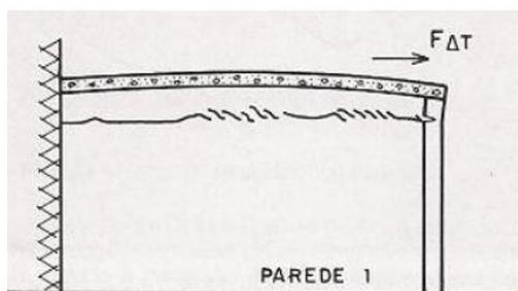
Fissuras que ocorrem nas lajes por movimentações térmicas, tipicamente horizontais, linha paralela à laje (Thomaz, 1989).
